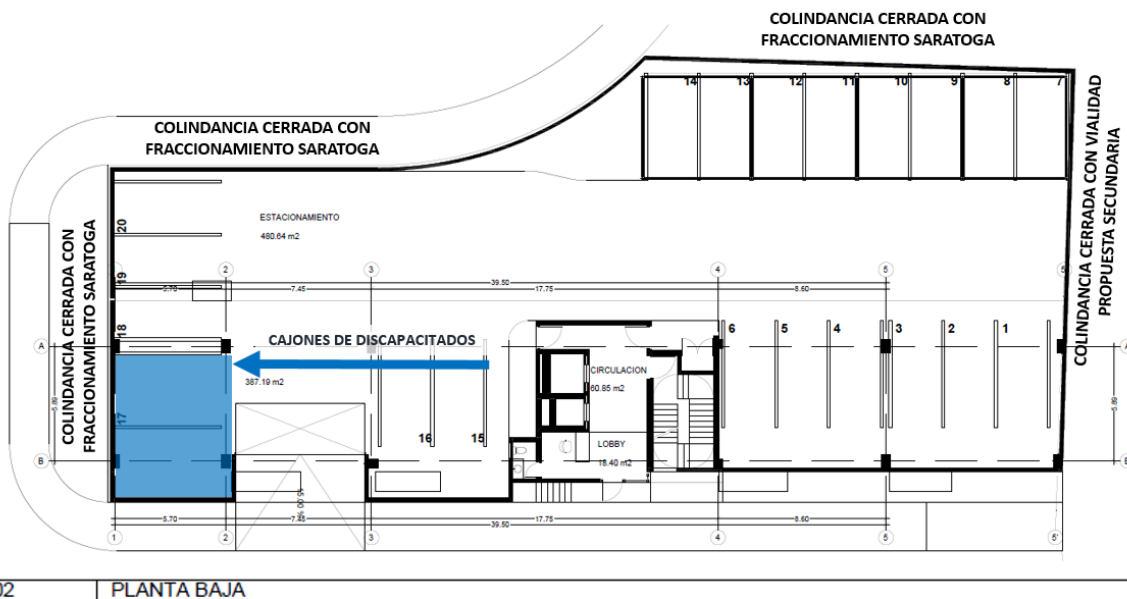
Esquema de Estacionamientos de Discapitados de Planta Baja. Fuente: Elaboración Propia 2025.
